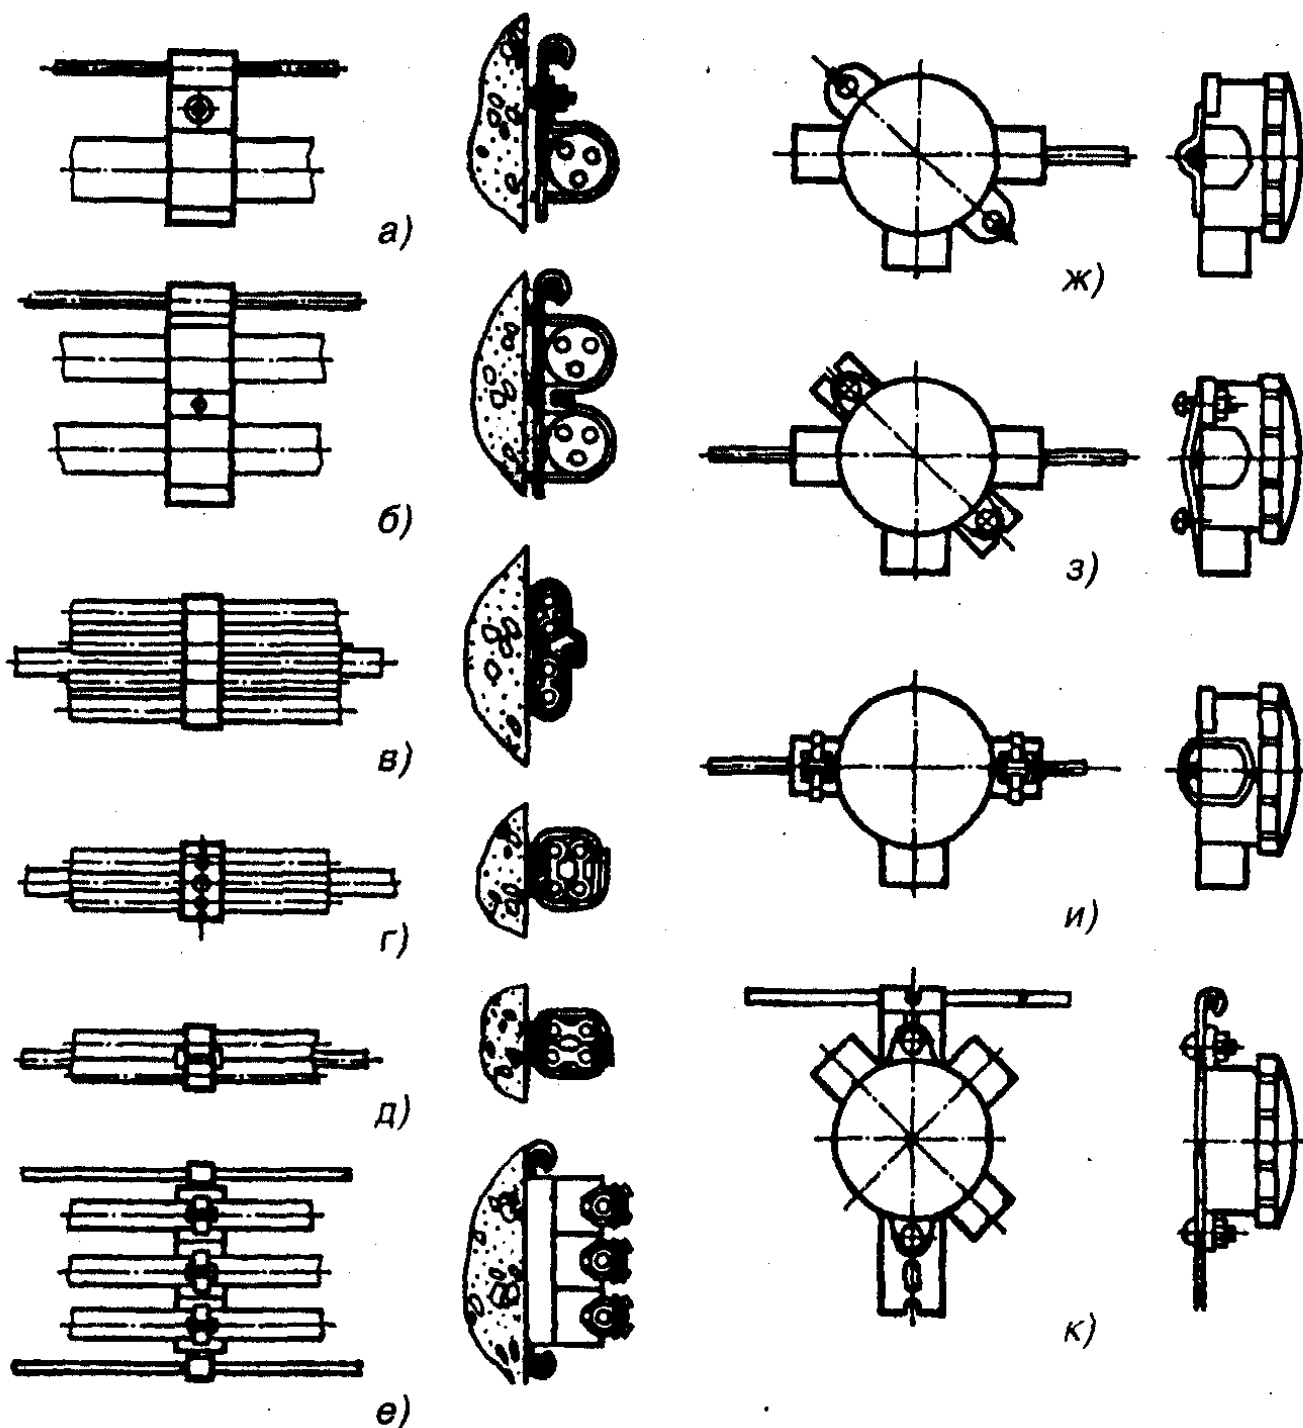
Прокладка кабеля и проводов по стене с креплением к струнам:
